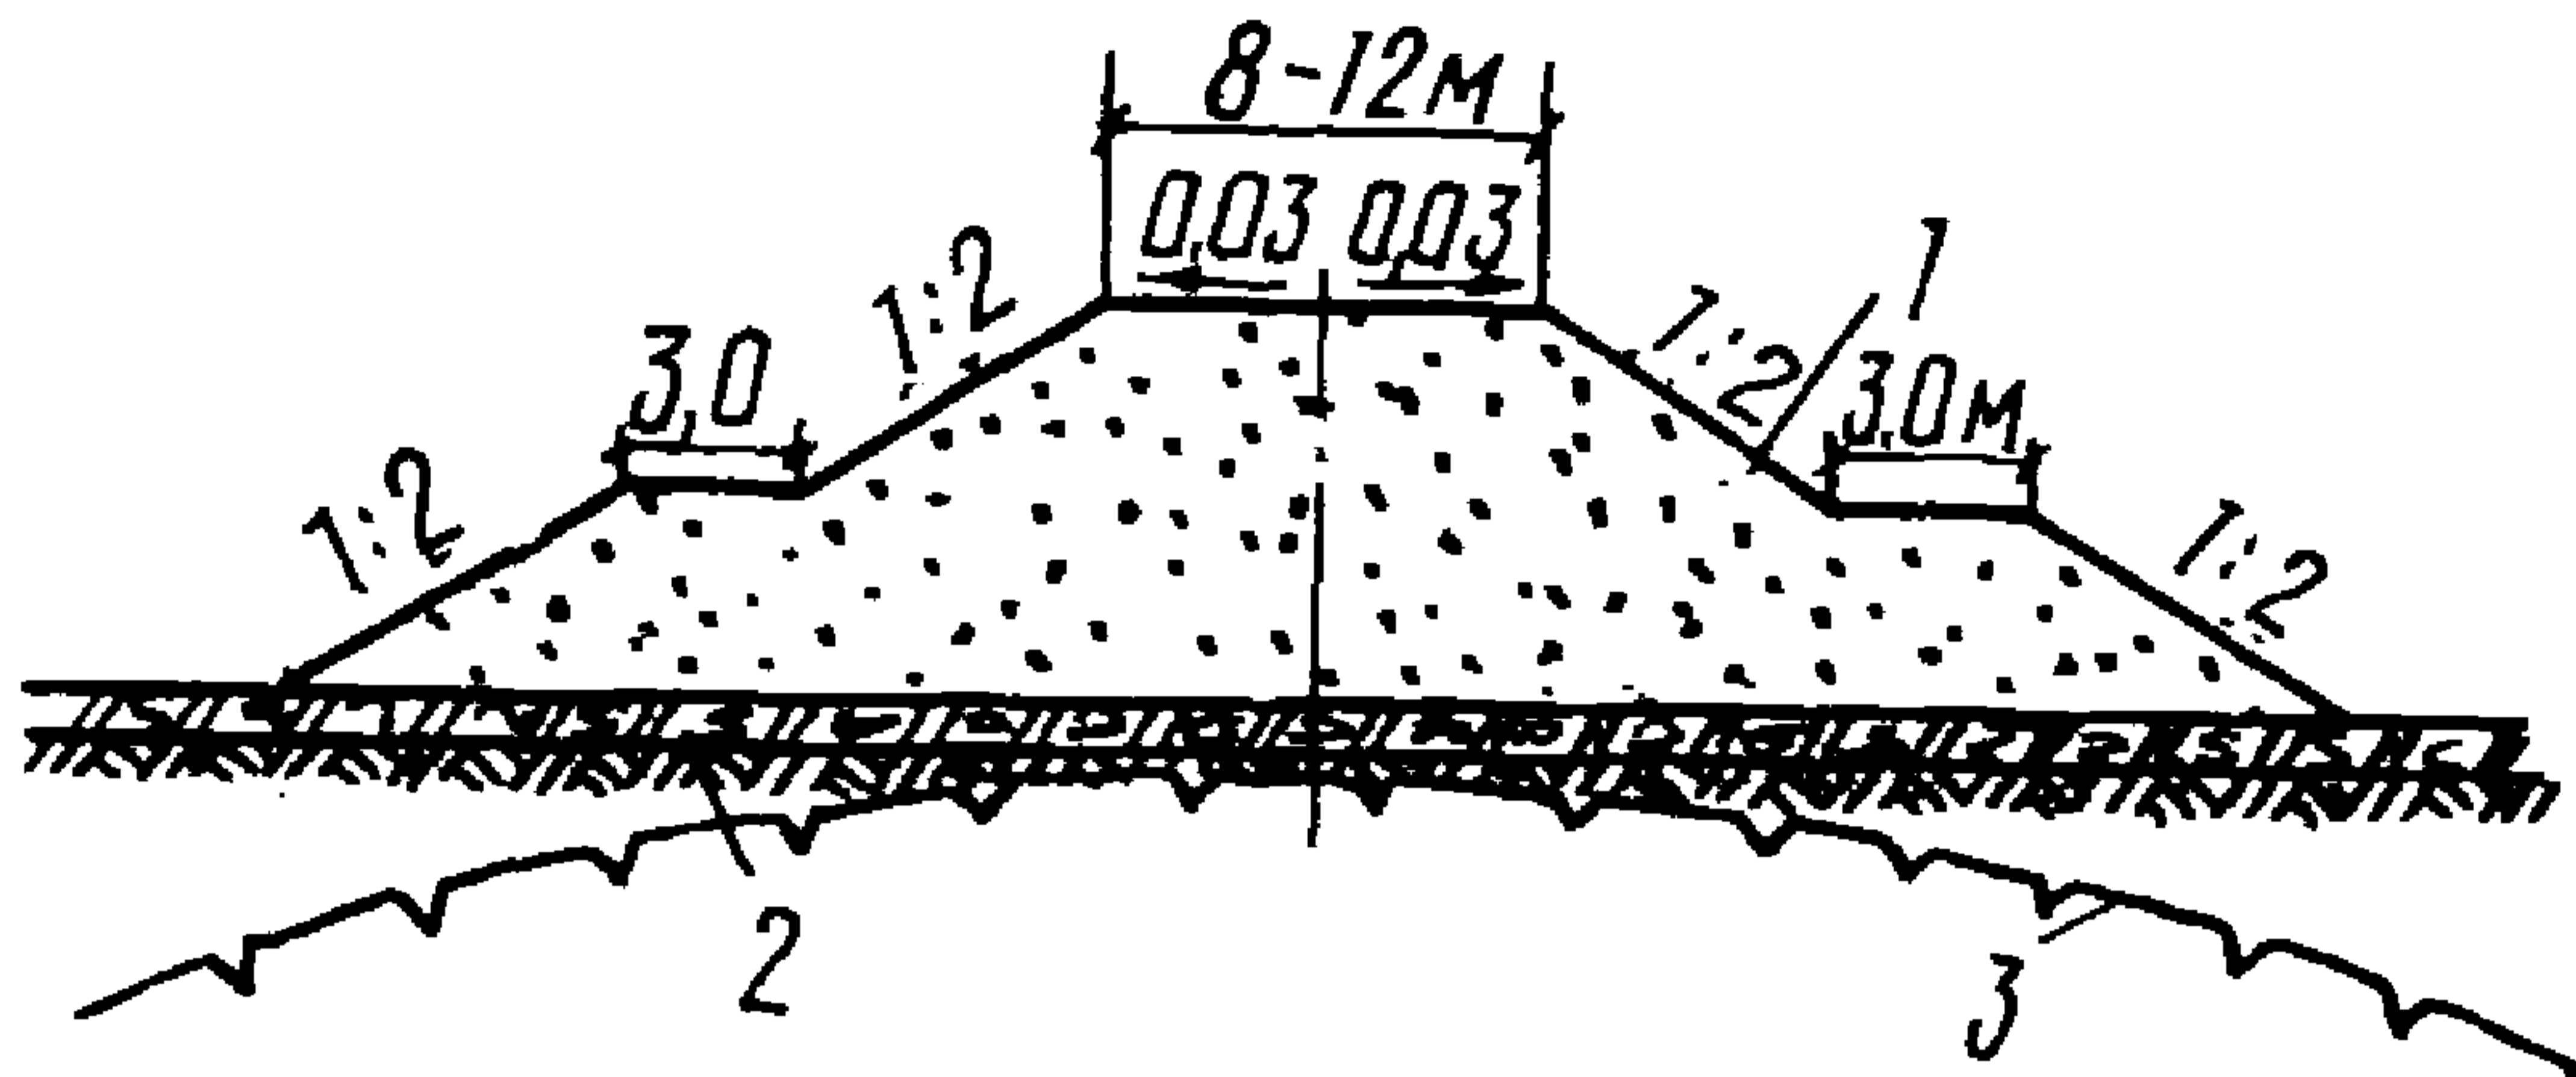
Поперечный профиль насыпи на участках второй группы ландшафтных комплексов при раздельной прокладке трубопроводов и дороги:
